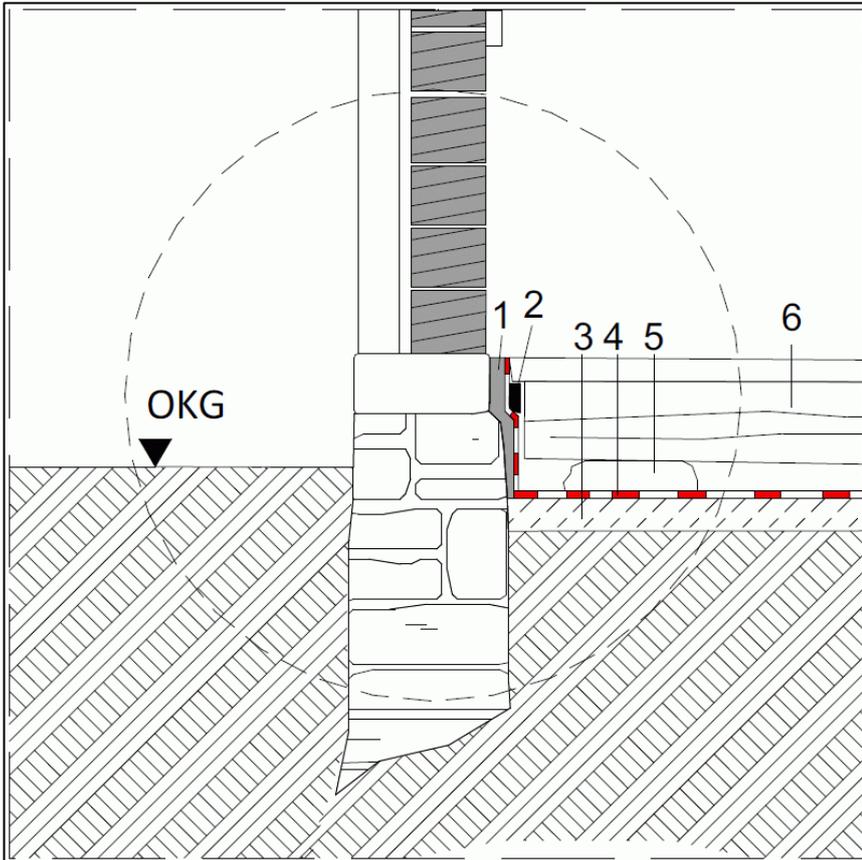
Beispiel Umgebäudehaus: Außenwandanschluss, Sanierungsvariante 1
